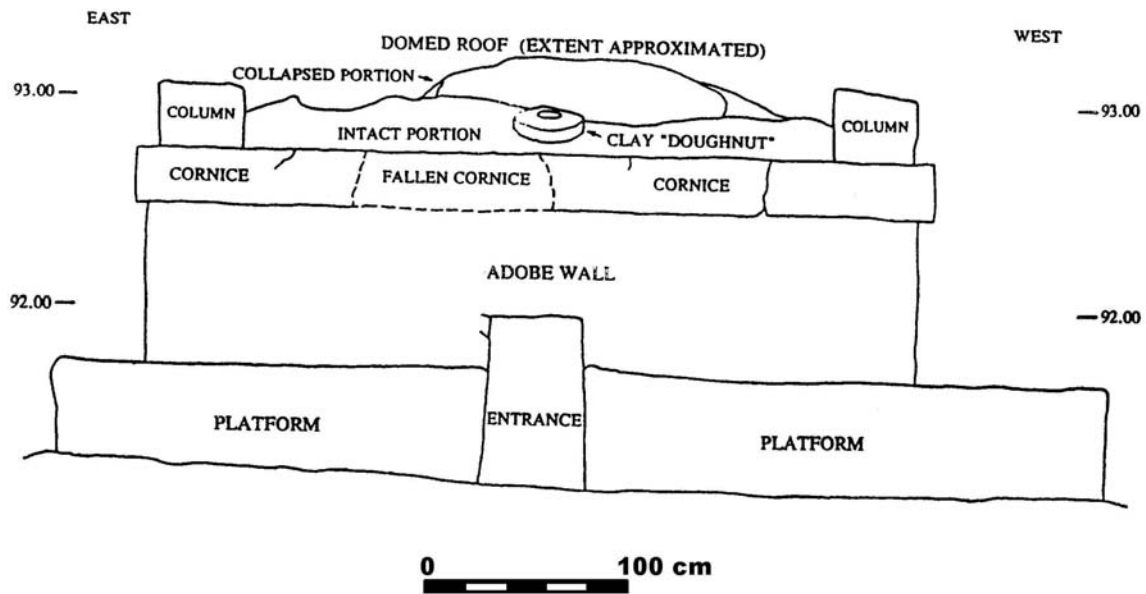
Perfil del lado norte de la Estructura 9, Cerén
